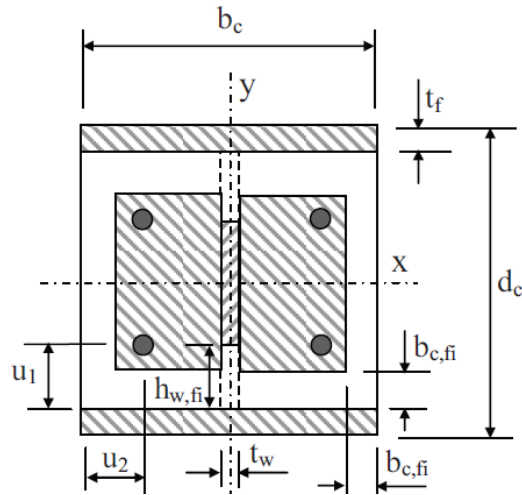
Seção transversal reduzida para o dimensionamento em situação de incêndio
